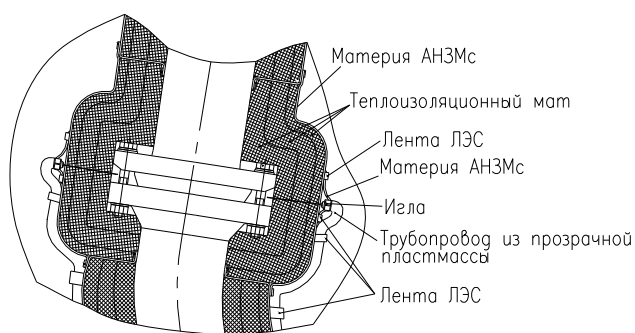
Установка иглы в разъемное соединение под теплоизоляционное покрытие
